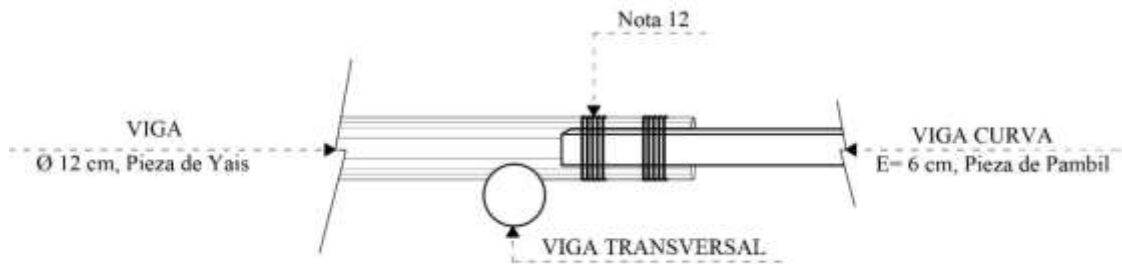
Unión viga longitudinal – viga transversal
